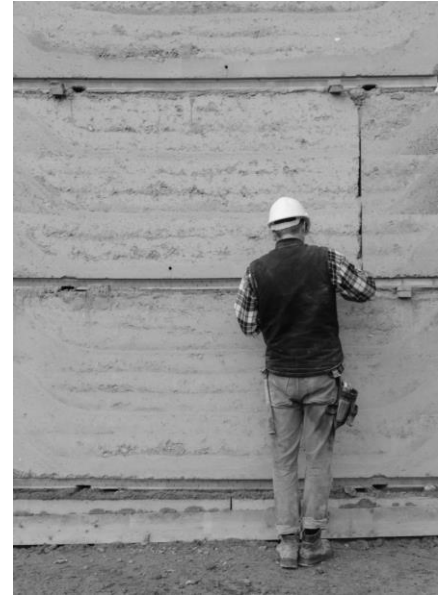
Travail de lissage et de finition d'un mur en terre crue.
